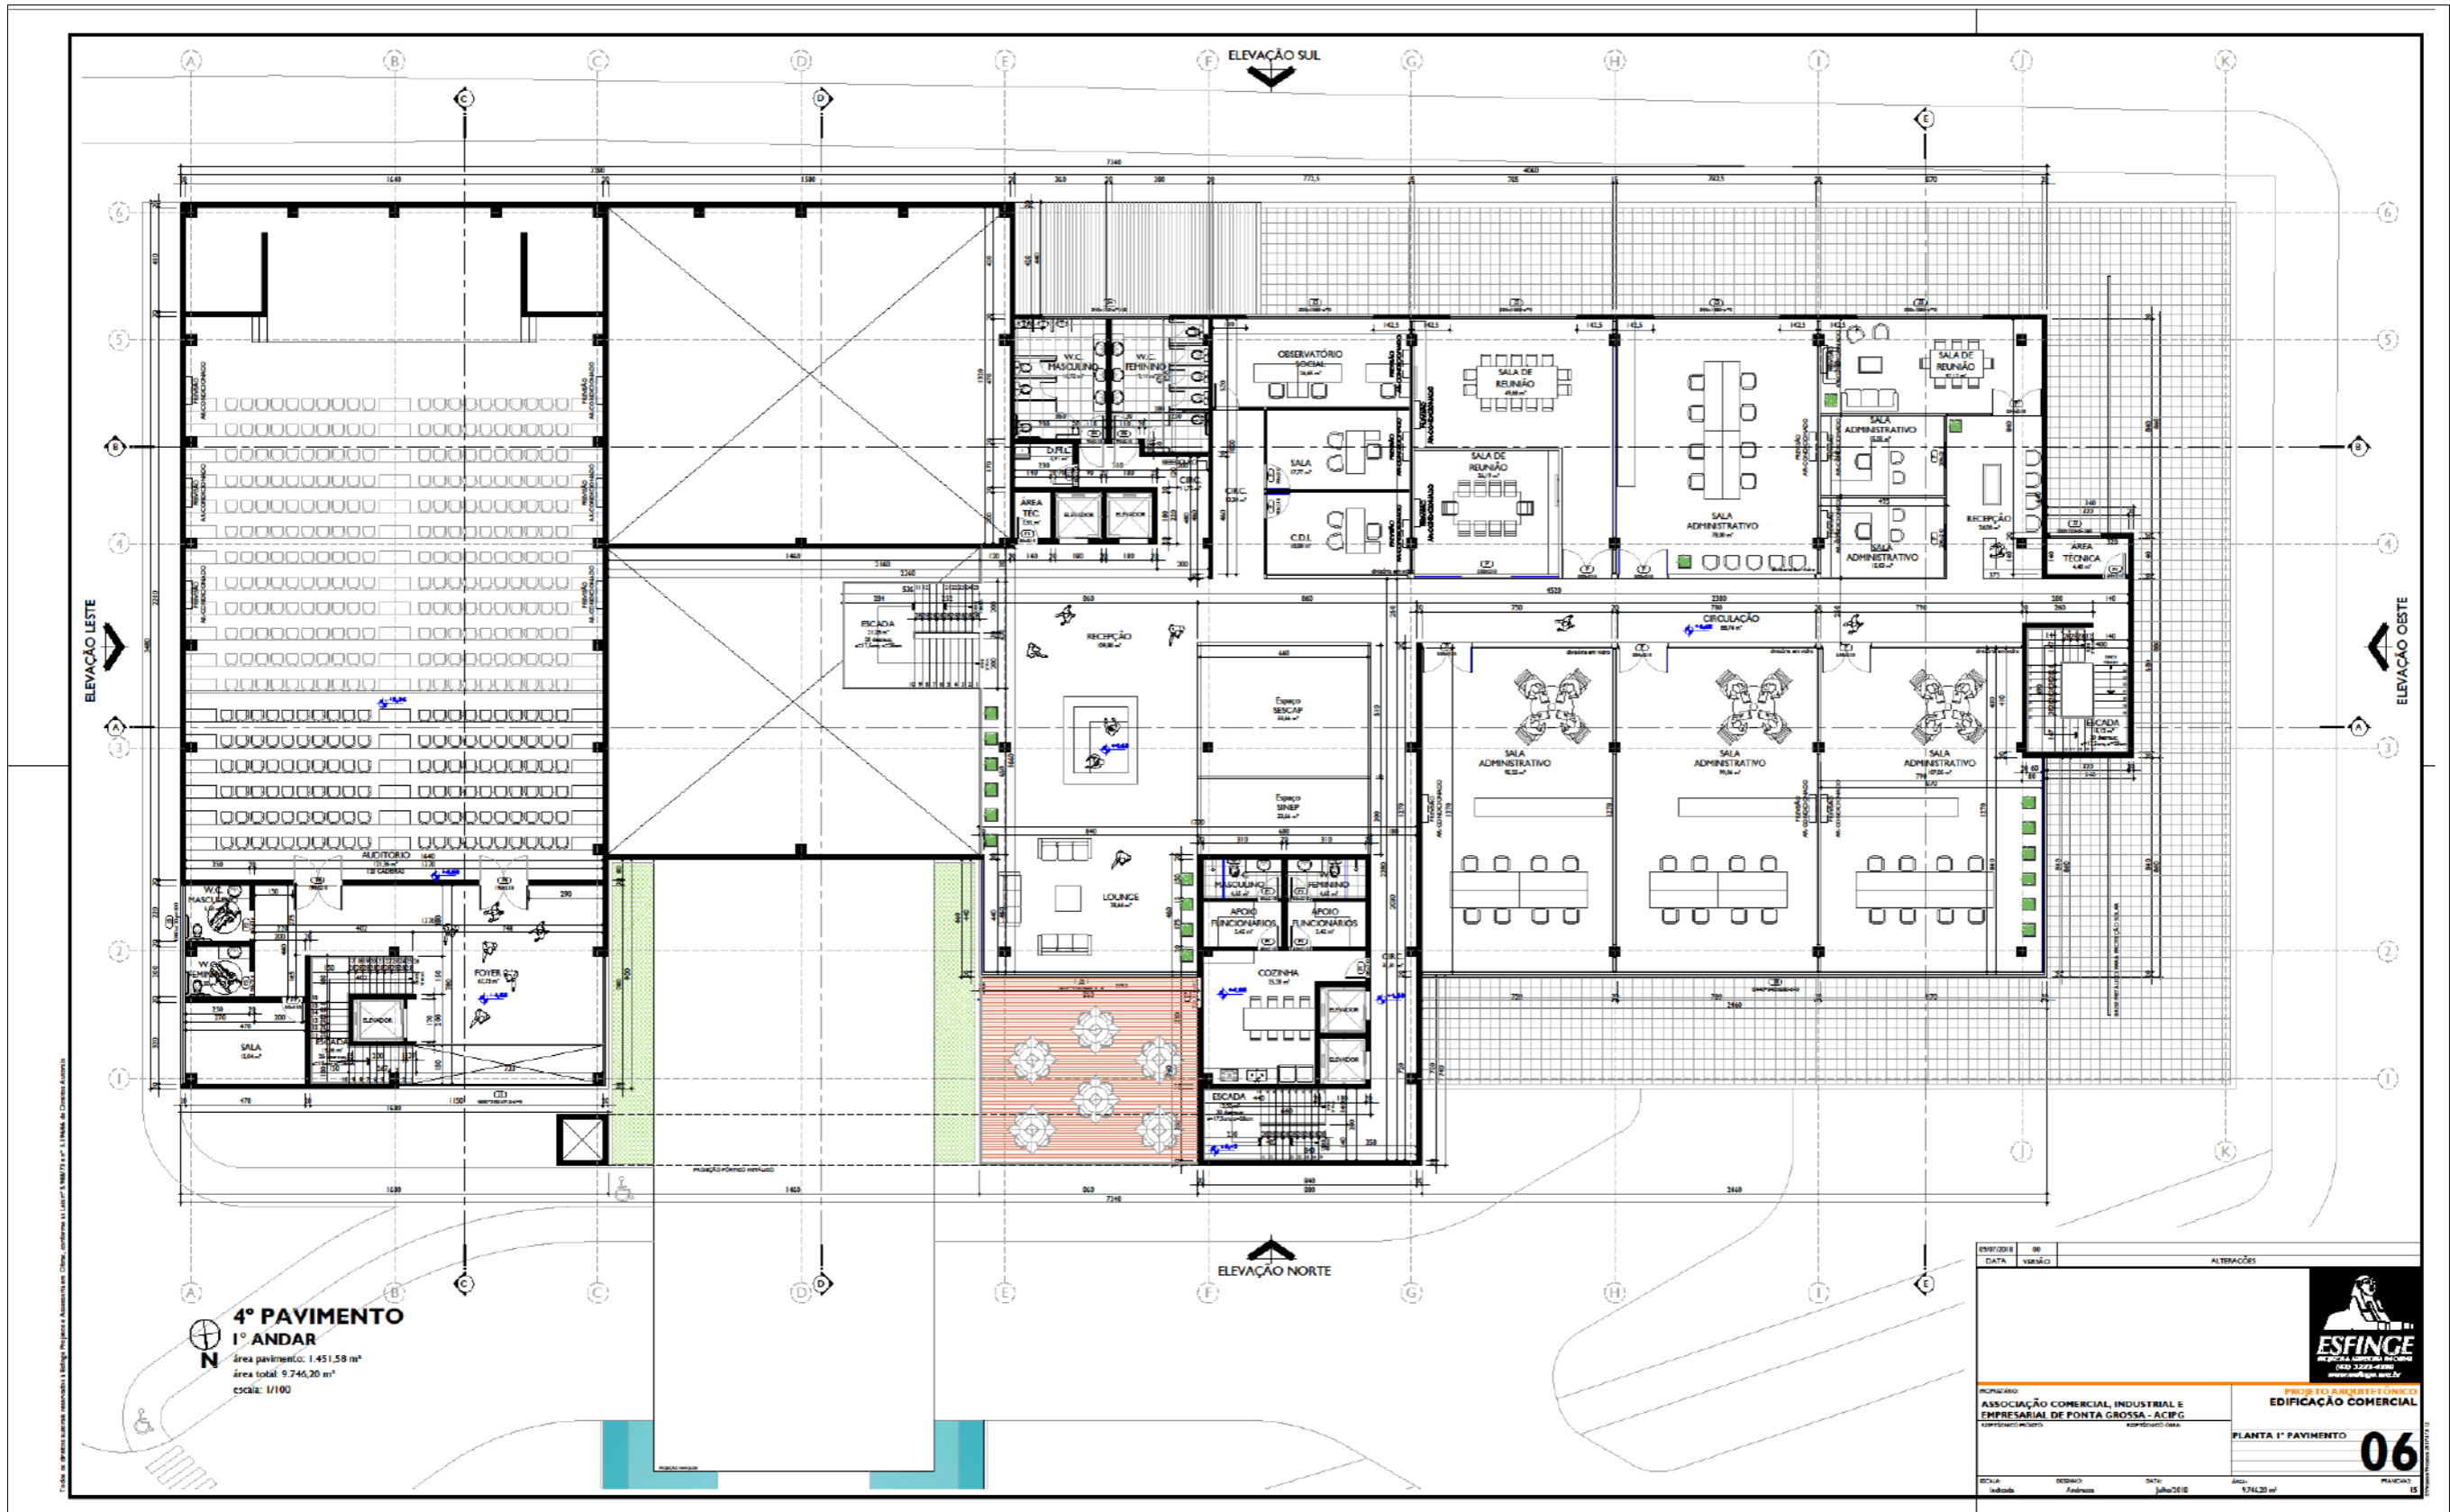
Planta 1º pavimento. Fonte: Esfinge Arquitetura e Engenharia (2018).
